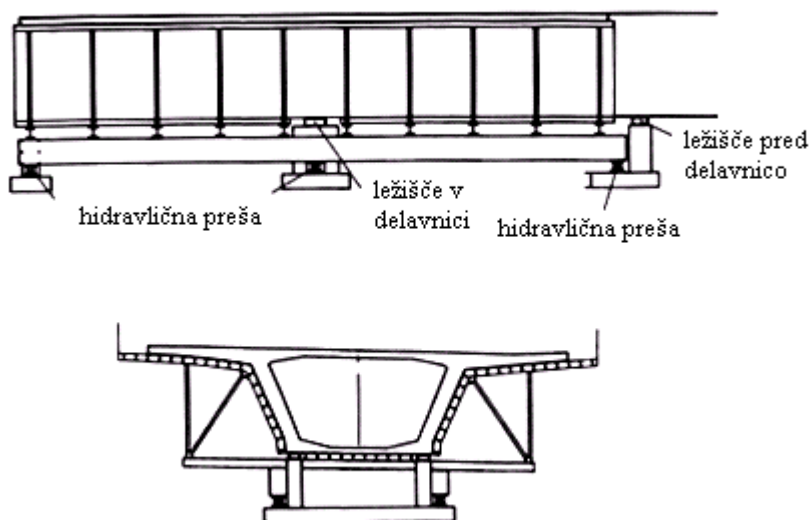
Delavnica z neprekinjenim podpiranjem takta
